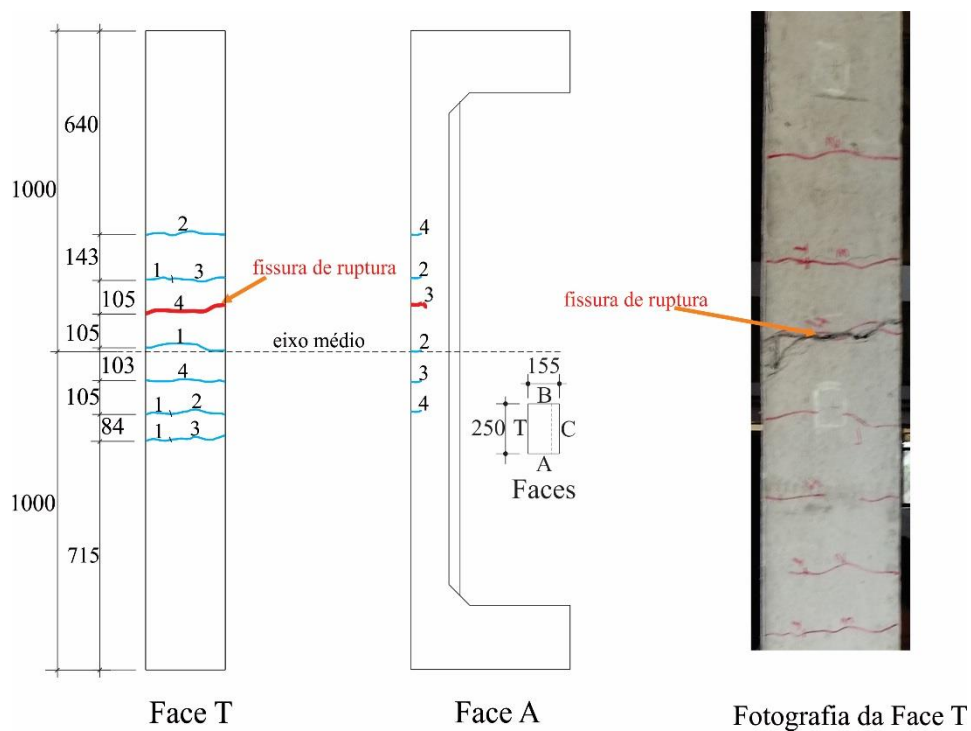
57 - Fissuras nas Faces T e A; Fotografia da face T - pilar PPBA-150-34-SP
